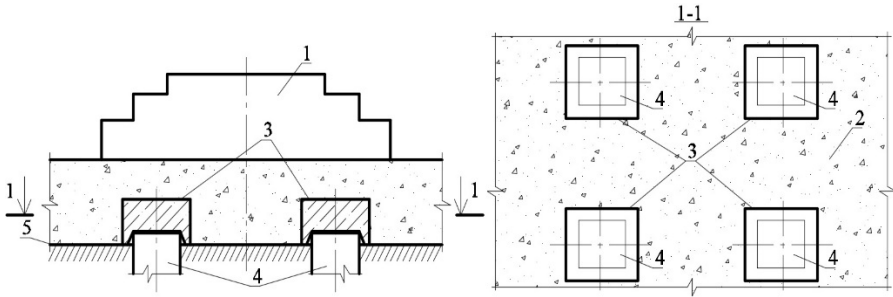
Свайный фундамент с промежуточной подушкой: 1 – фундаментный блок; 2 – промежуточная подушка; 3 – железобетонные оголовки; 4 – железобетонные сваи; 5 – поверхность дна котлована
